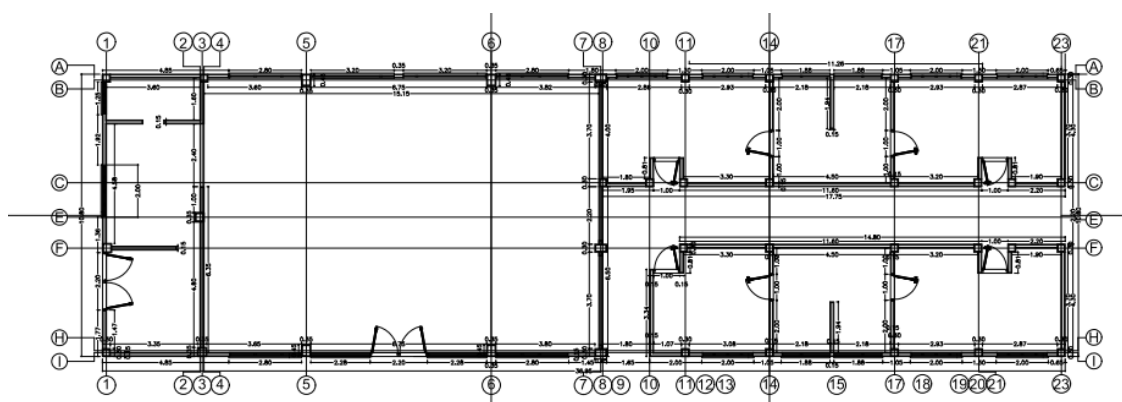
Planta del Levantamiento Estructural – Planta de Ejes estructurales
